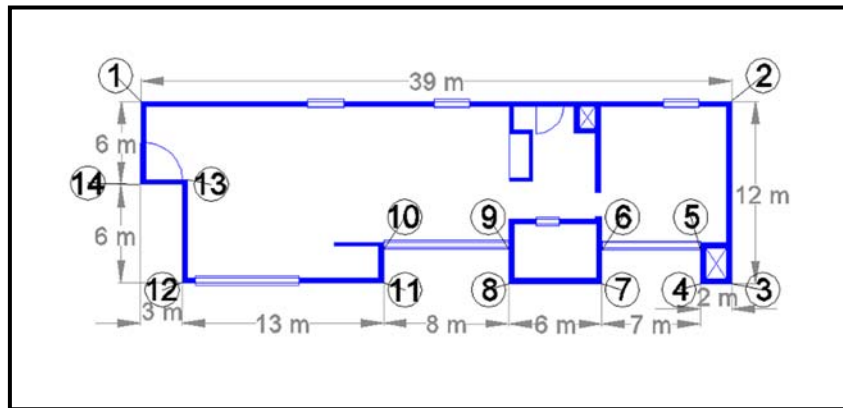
Ejemplo de esquema en planta del obstáculo que se pretende construir
